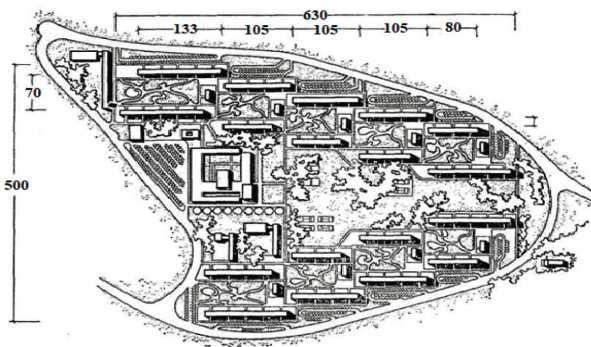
Планувальне рішення житлового району з рядовою забудовою
